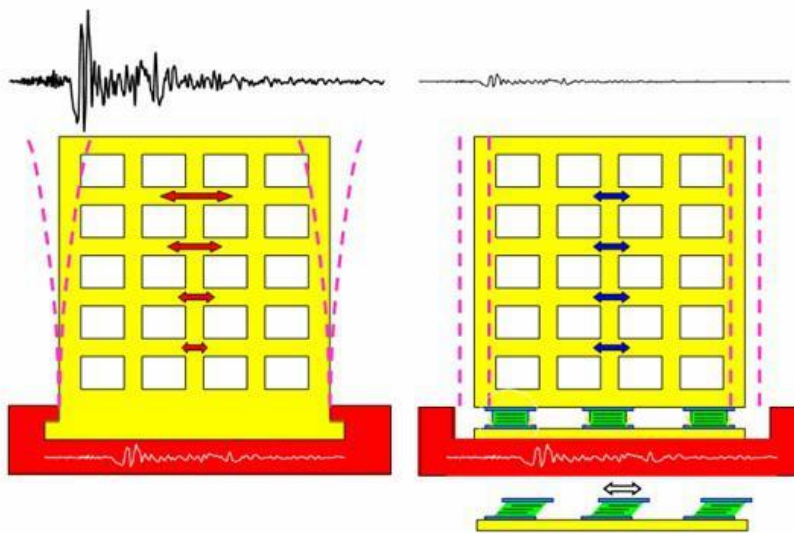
Desplazamientos laterales en estructura convencional y aislada
